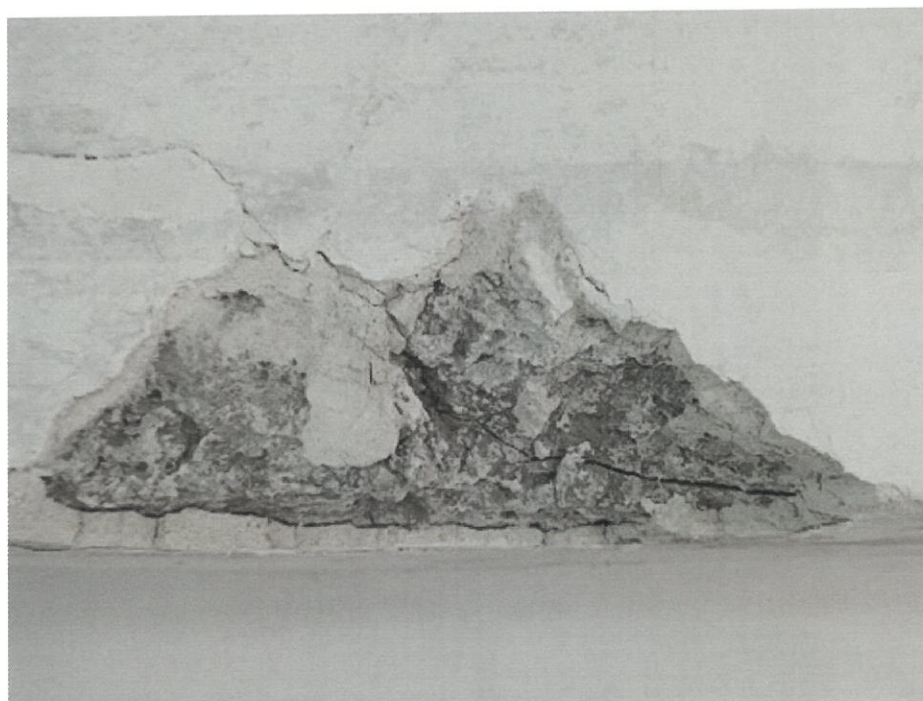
Sonda ke zjištění průběhu praskliny na styku stropního trámu a průvlaku - detail
